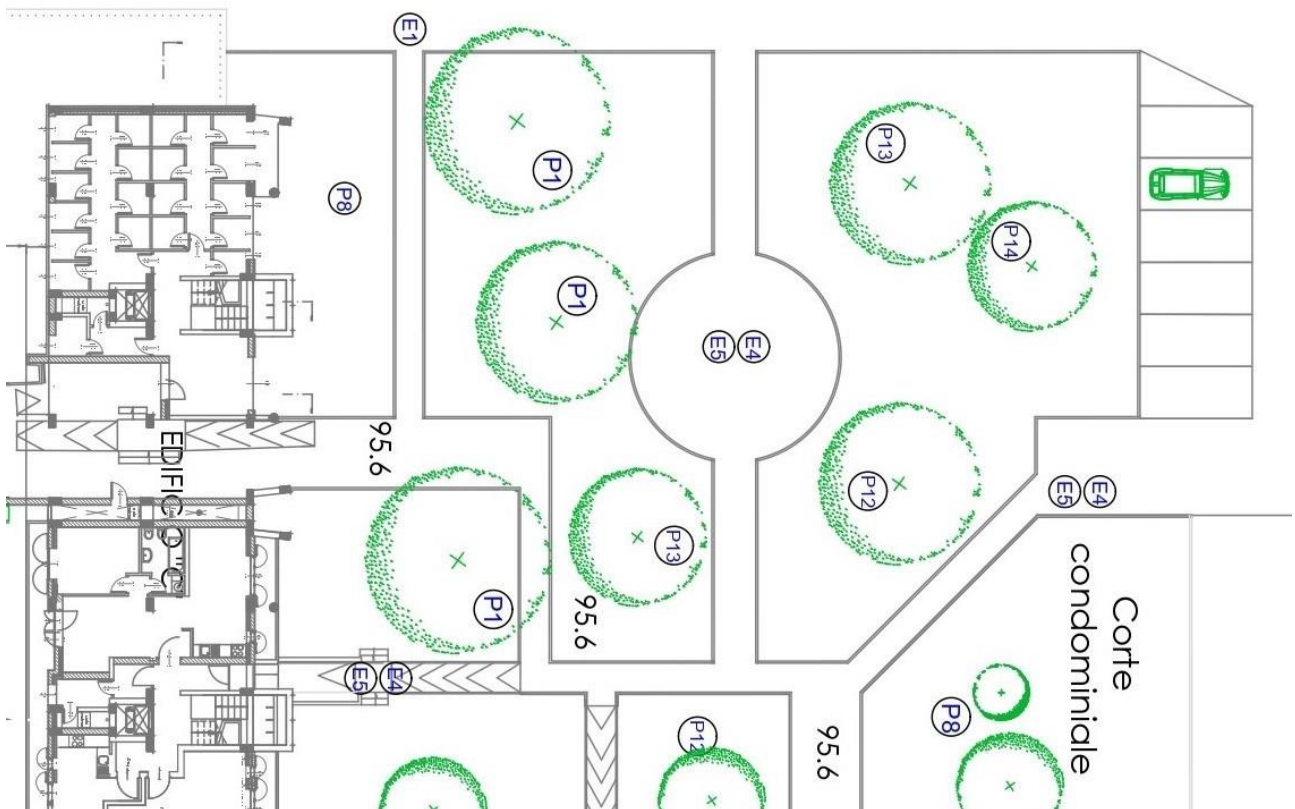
AREA A VERDE IN SOSTITUZIONE DELL'EDIFICIO D ELIMINATO DALL'INTERVENTO
